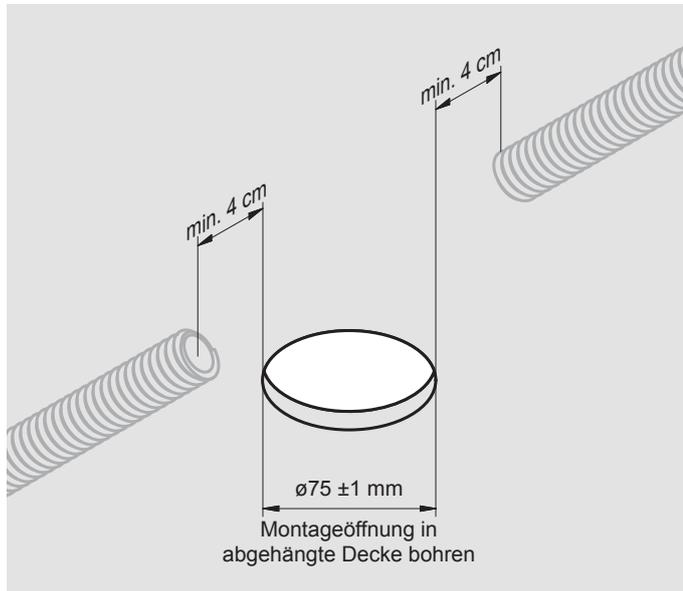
Montageöffnung in die abgehängten Decken bohren
